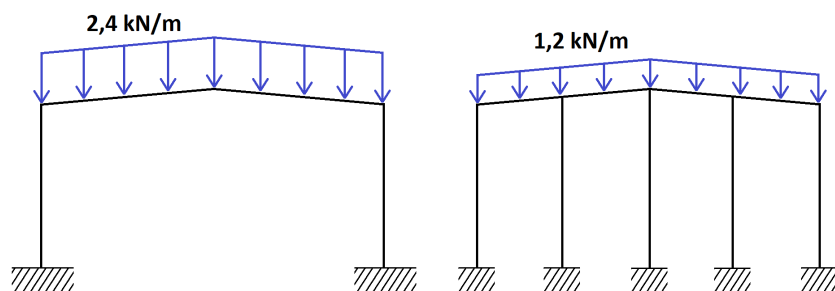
Sobrecarga de uso sobre los pórticos interiores y de fachada
